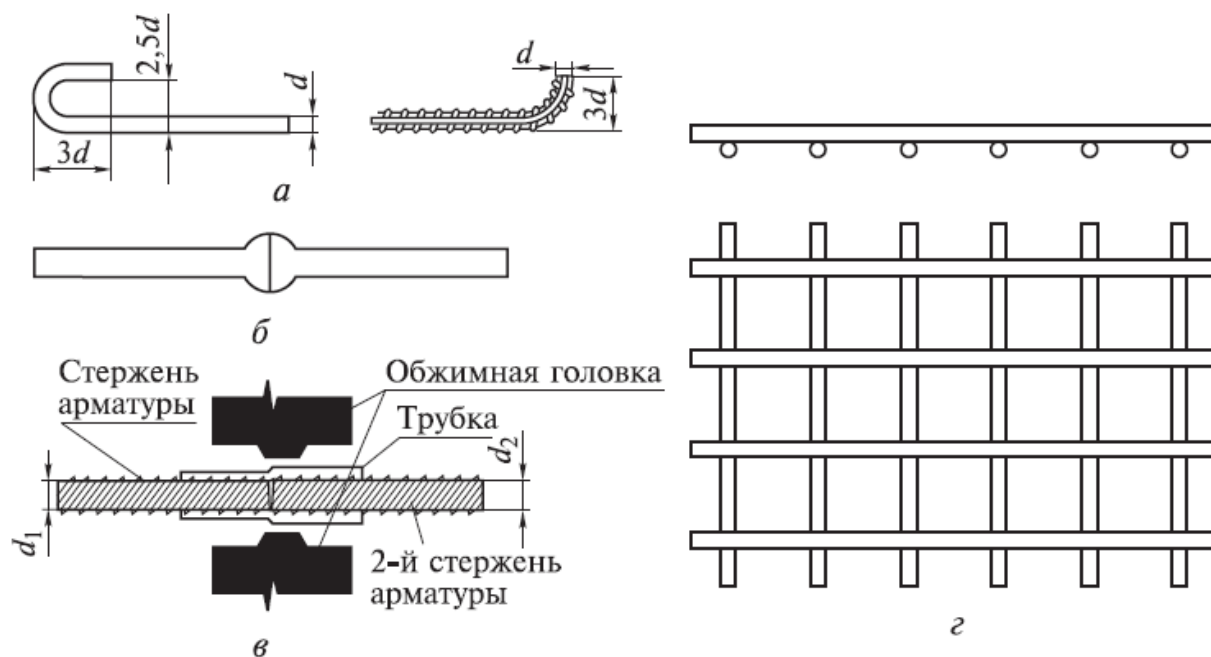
Отдельные стержни арматуры (а), арматурные сетки (б) и способы стыковки стержней (в, г)
